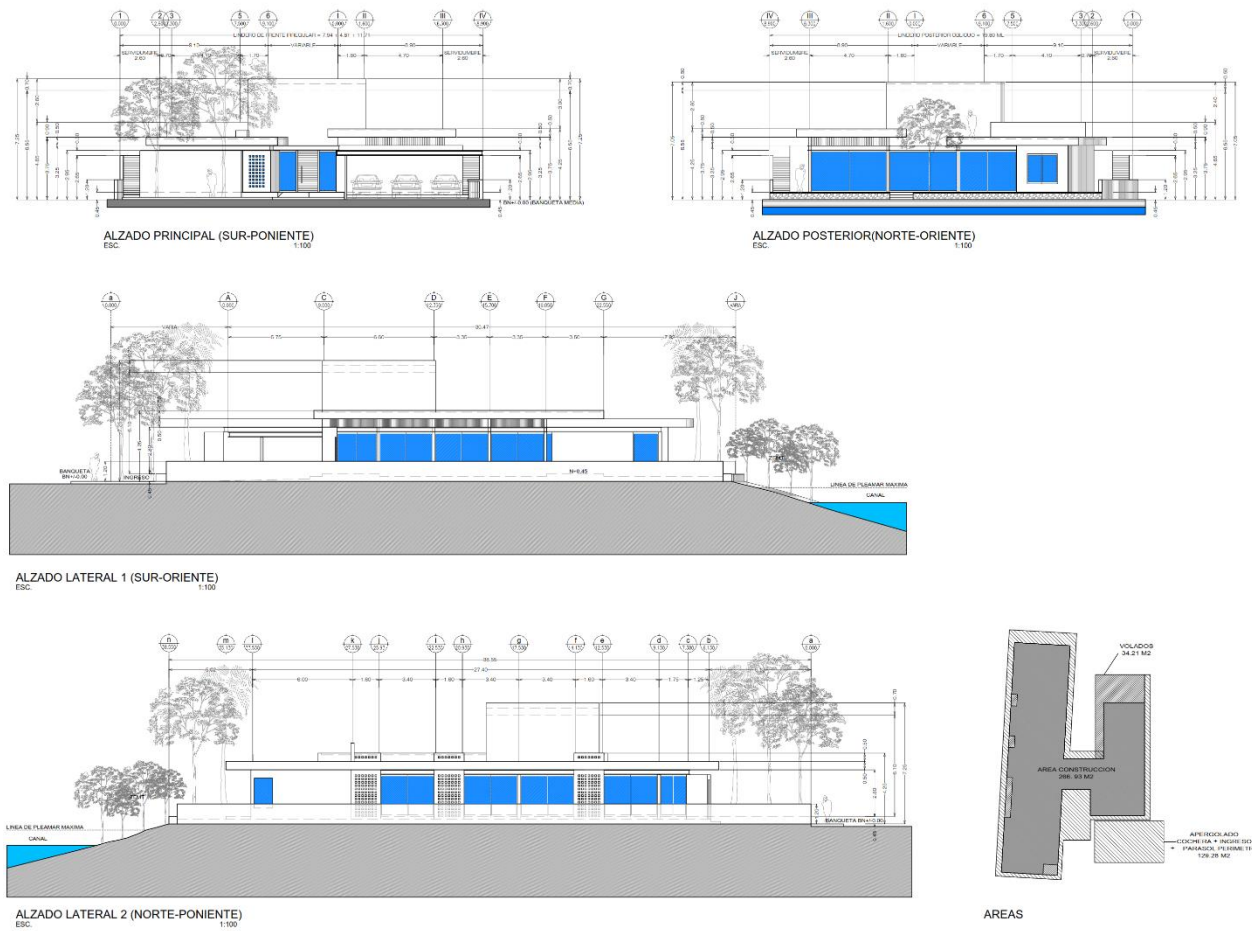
Alzado principal, alzado posterior, alzado lateral 1 y alzado lateral 2
